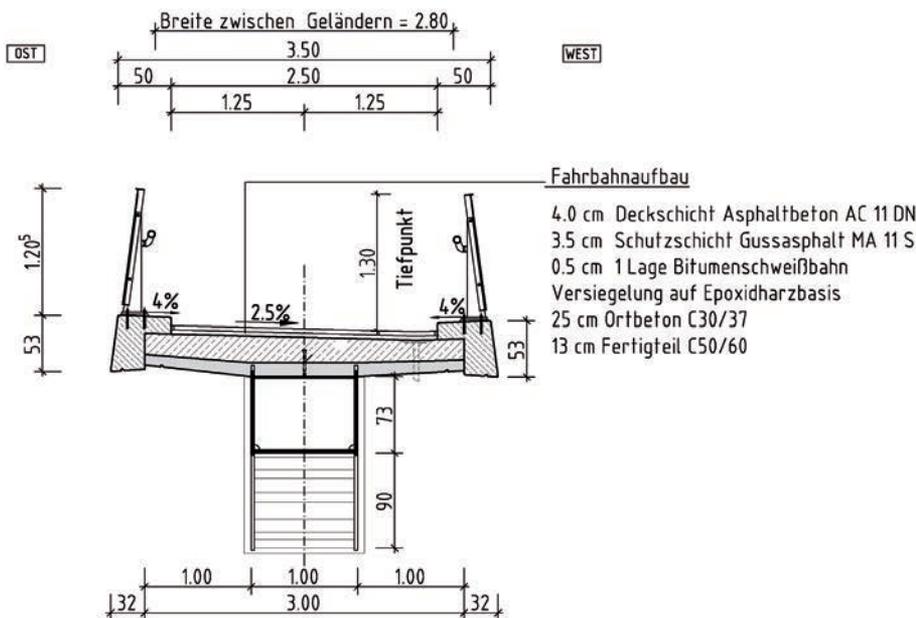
Querschnitt der Fußgängerbrücke (© SSF Ingenieure)
